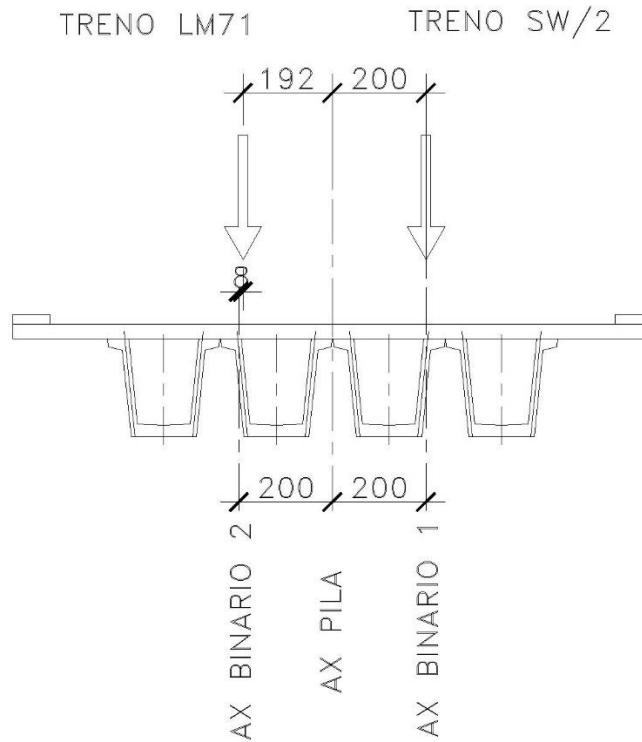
Configurazione di carico 2 – Disposizione dei carichi in direzione trasversale
